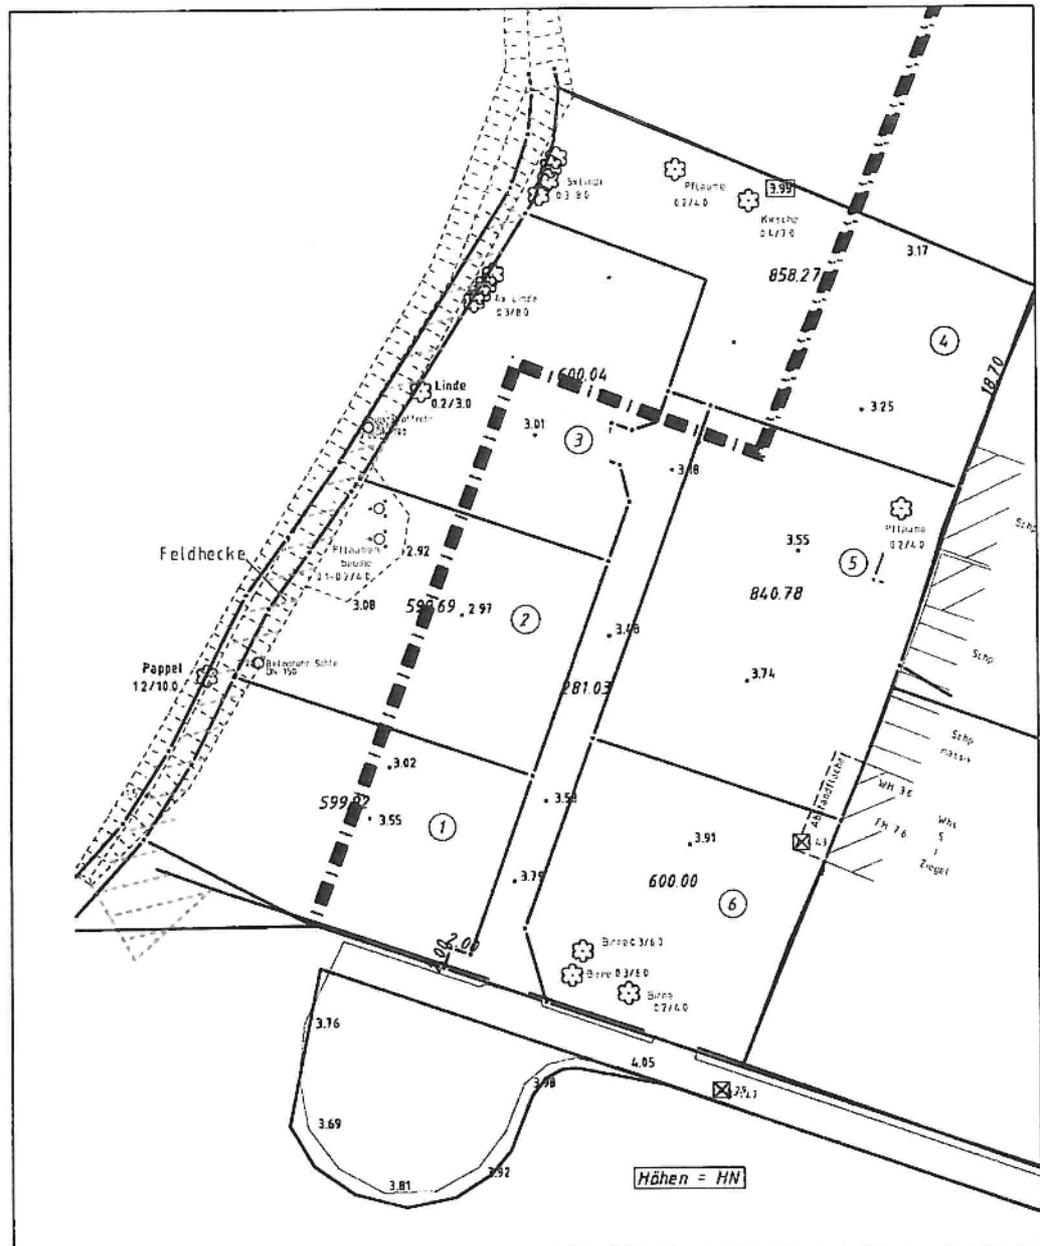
Städtebaulicher Lageplan des Vorhabenträgers Planstand 04.08.2017
